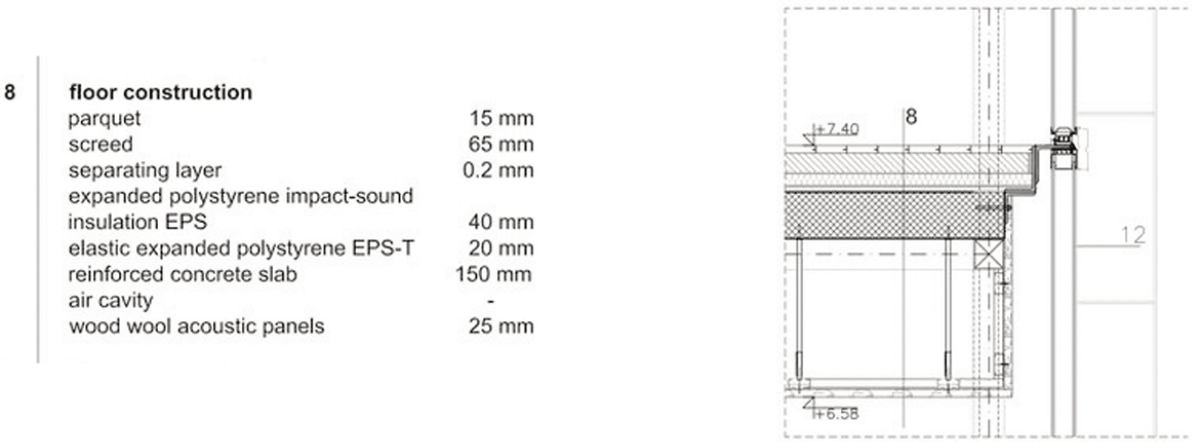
Detalhe construtivo da relação entre piso e fachada do Zamet Cultural Center (caso de estudo apresentado no Capítulo 3).
